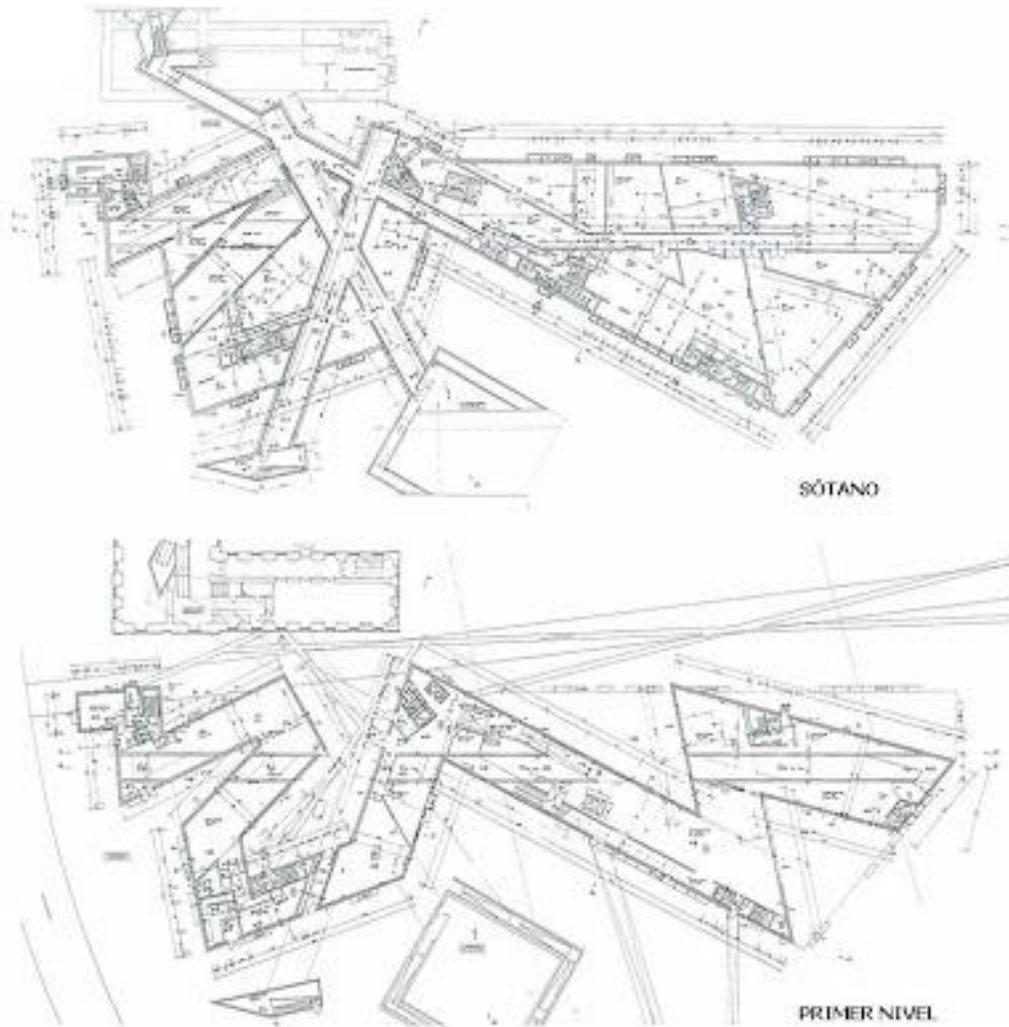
Plantas Arquitectónicas Museo Judío de Berlín. Plataforma Arquitectura.
